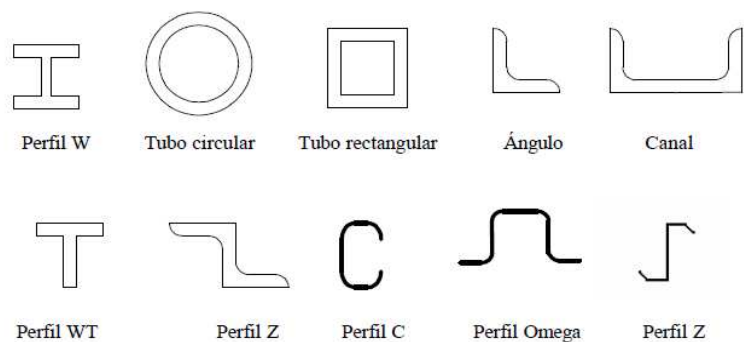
Perfiles comunes utilizados en estructura metálicas.
